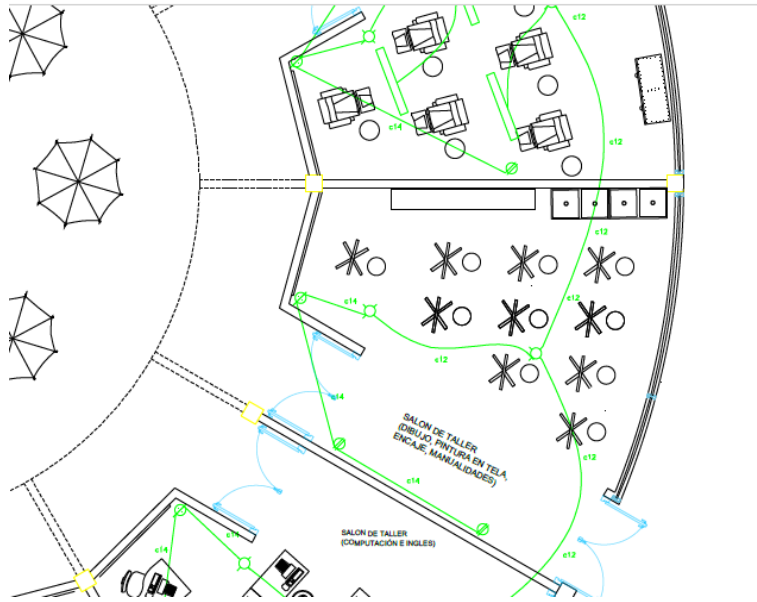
Detalle de Instalación eléctrica en Salón Taller
